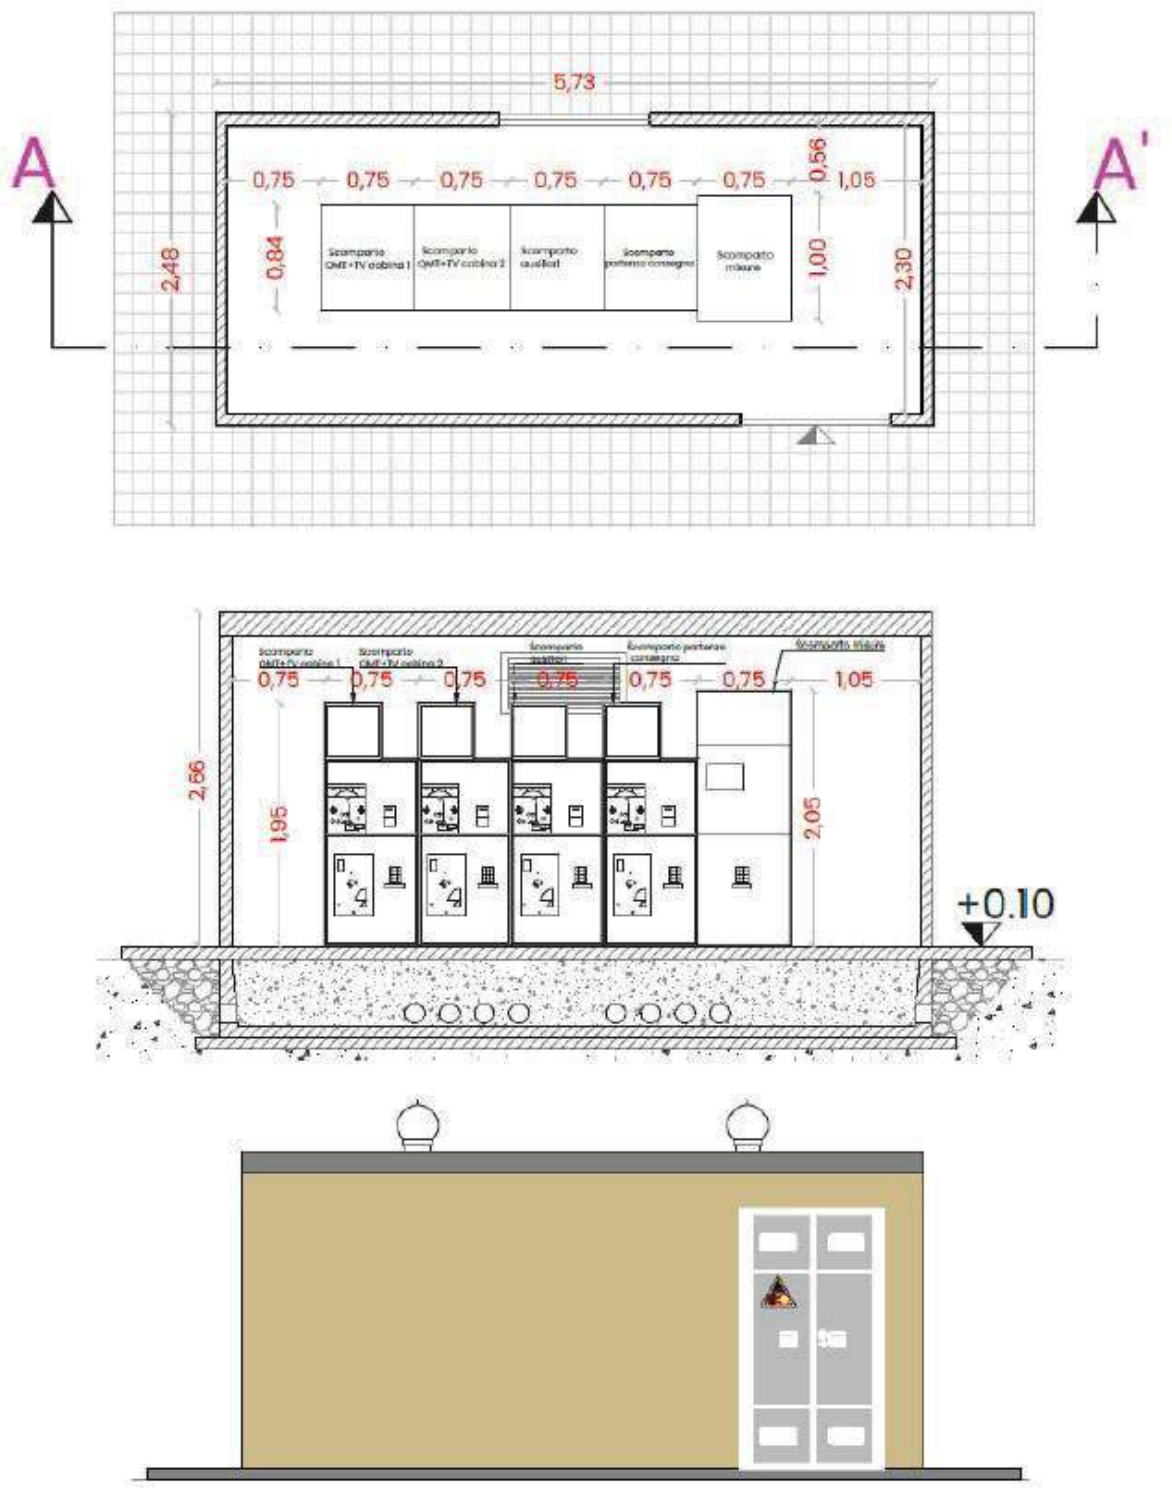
pianta, sezione e prospetto delle cabine di raccolta relative al progetto
